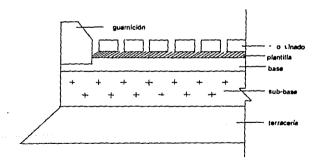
Sección típica de un pavimento de adoquín de concreto para tránsito pesado o industríal.
